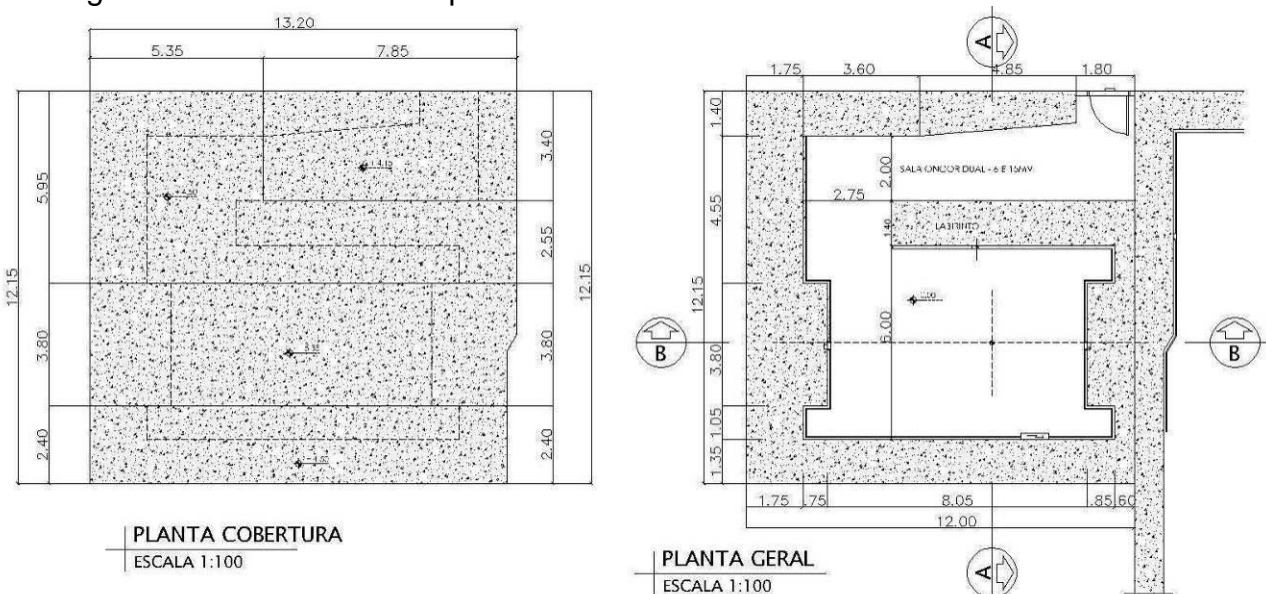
Planta da cobertura e planta geral da sala de radioterapia
